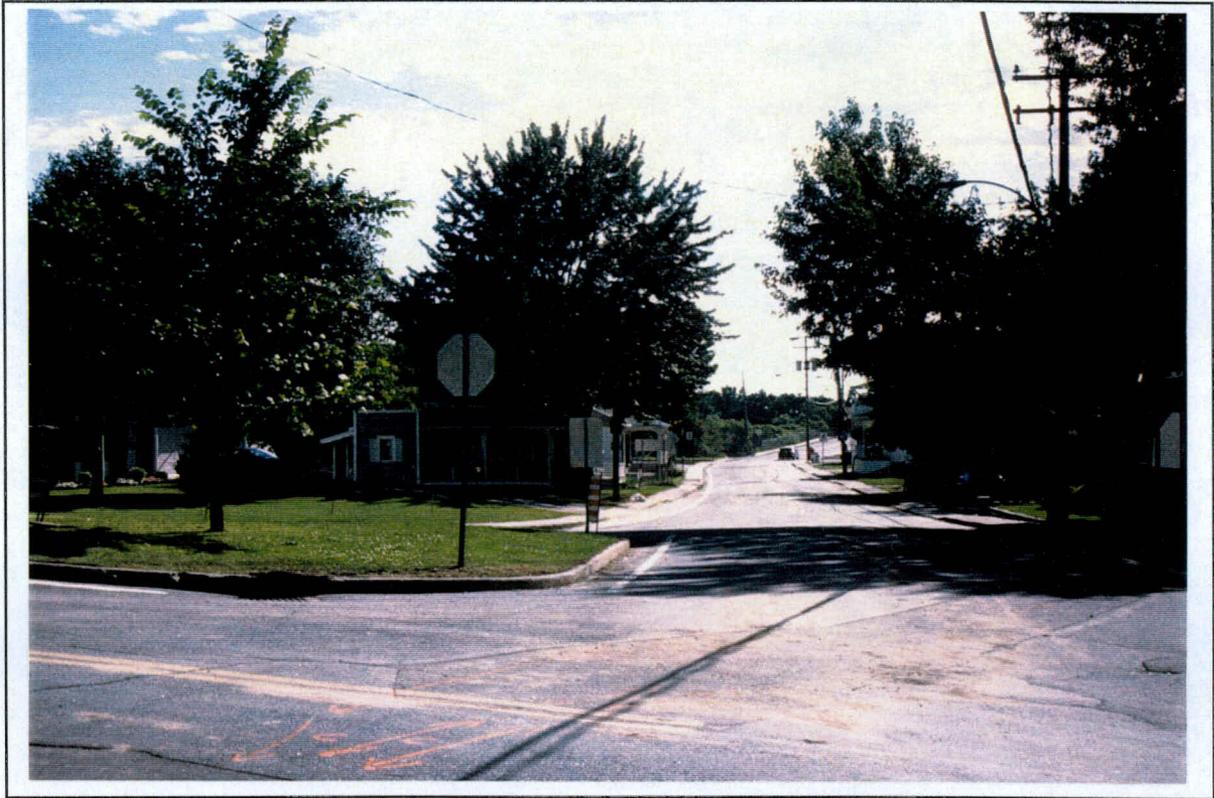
Projet 5372-9202, Route 132, secteur 1, vue d'ensemble du chaînage 0 + 000 à 0 + 100. (O)
